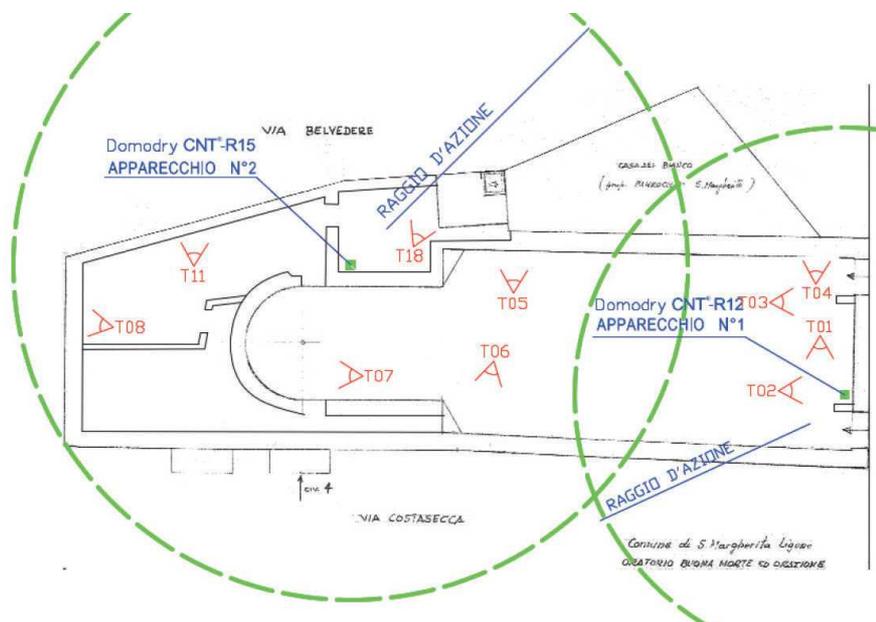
Schema planimetrico dei dispositivi CNT installati nell'aprile 2010
